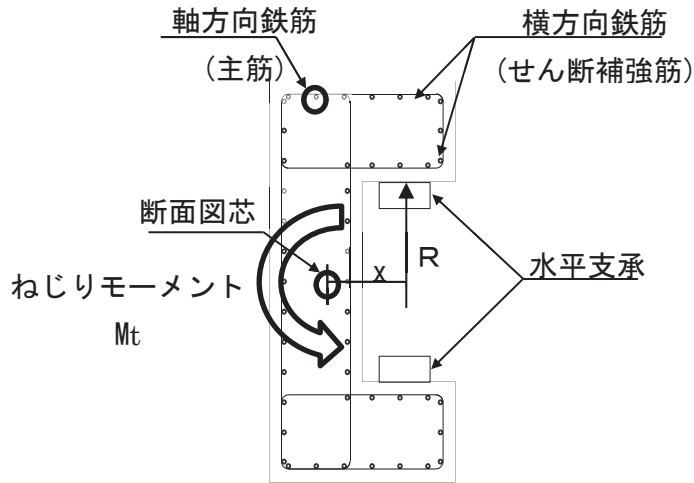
(2) RC 支柱へのねじりモーメント(反力)作用イメージ (平面図)
